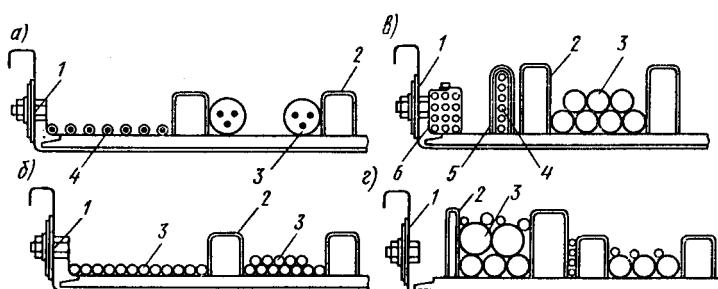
Прокладка проводов и кабелей на лотках:
